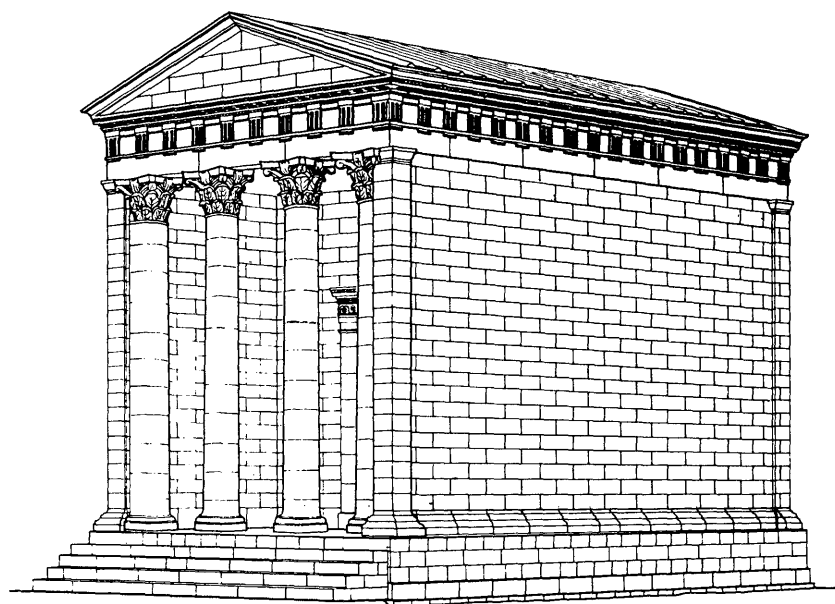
Ricostruzione grafica prospettica del «Tempio di Bacco», realizzata sulla base del rilievo delle strutture in elevato e delle membrature conservate nel crollo.
